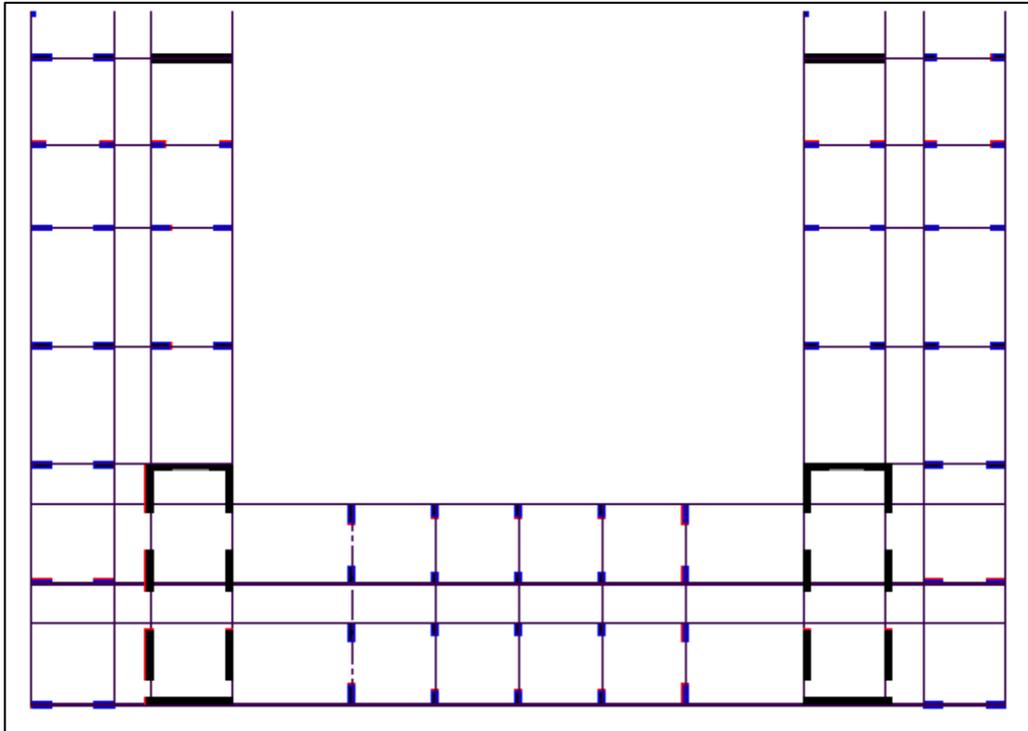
Denah Kolom Gedung Tanpa Dinding Geser Lantai Dasar Sampai Lantai 13 Tipe A
